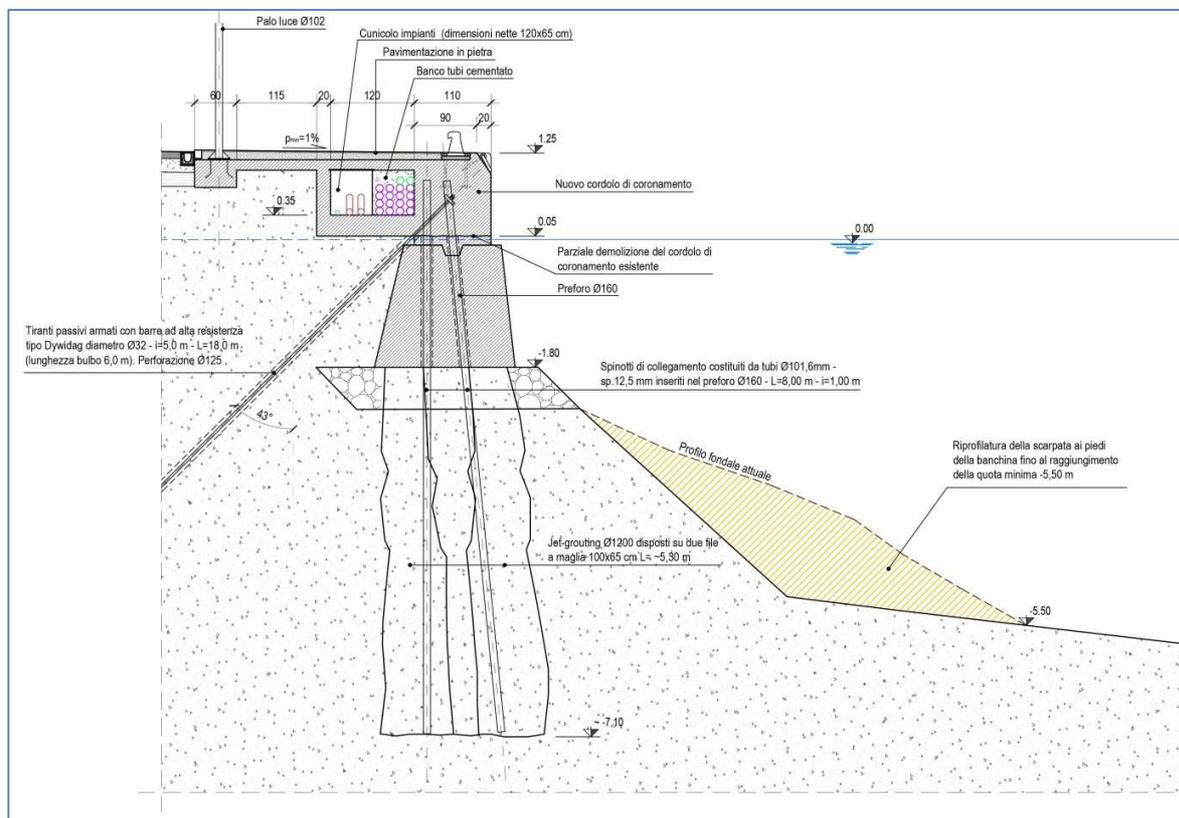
Sezione tipo rinforzo banchina piazzale
